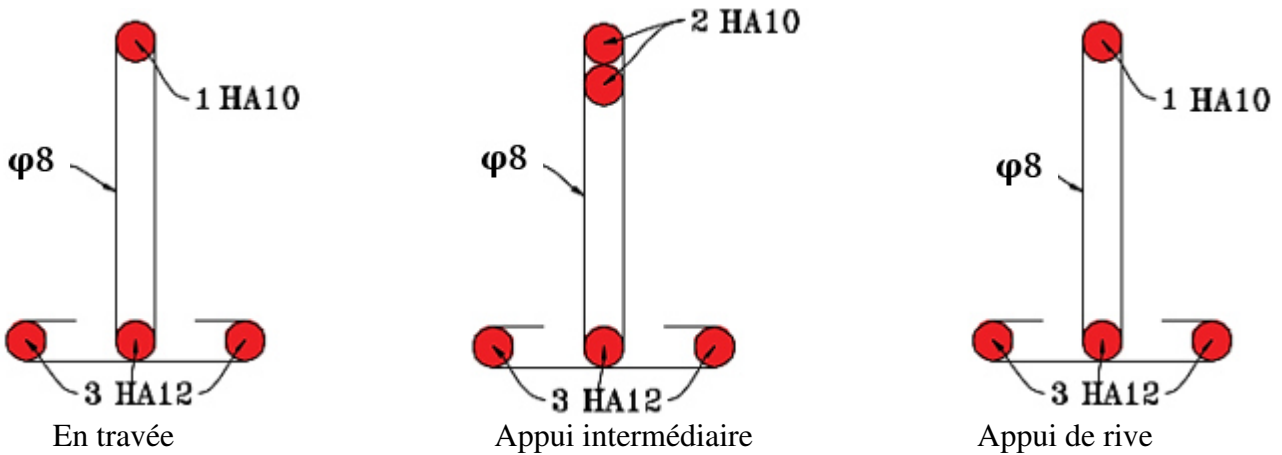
schémas de ferrailage des poutrelles plancher terrasse
